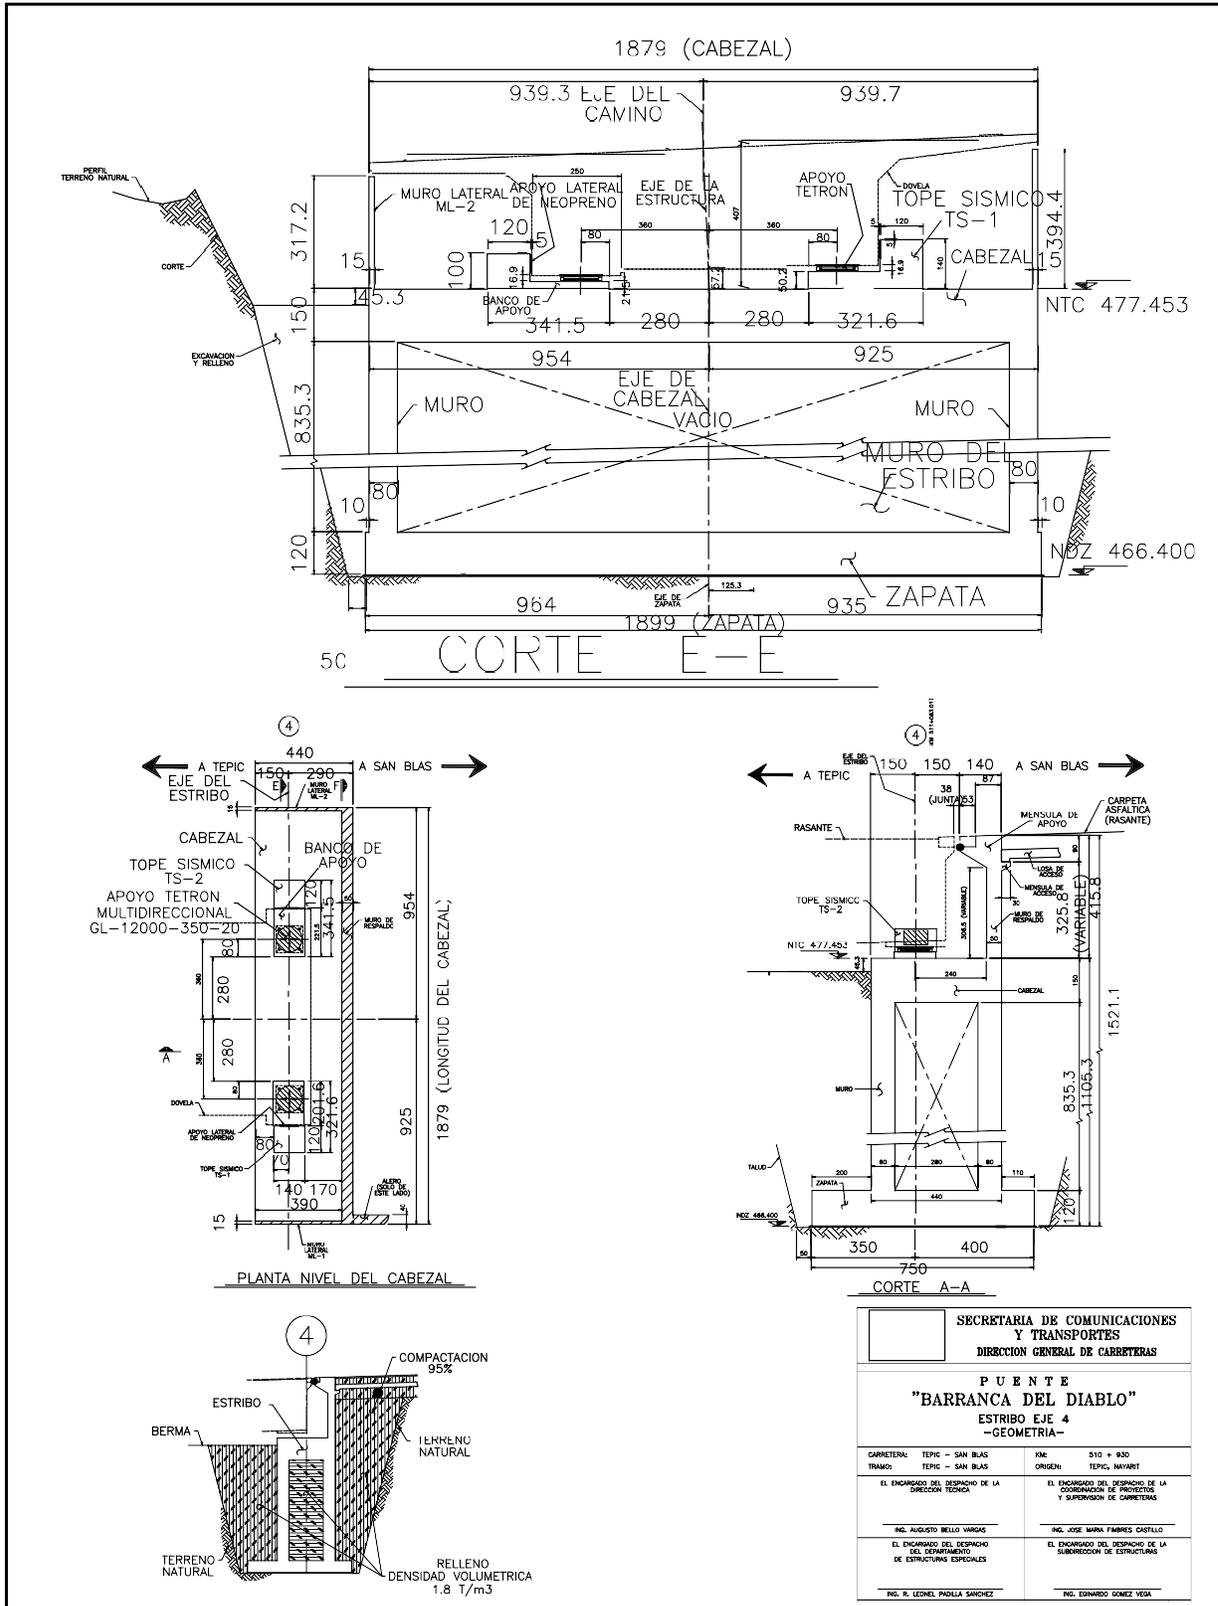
Detalles de los planos de las zapatas de los estribos E1 y E4
